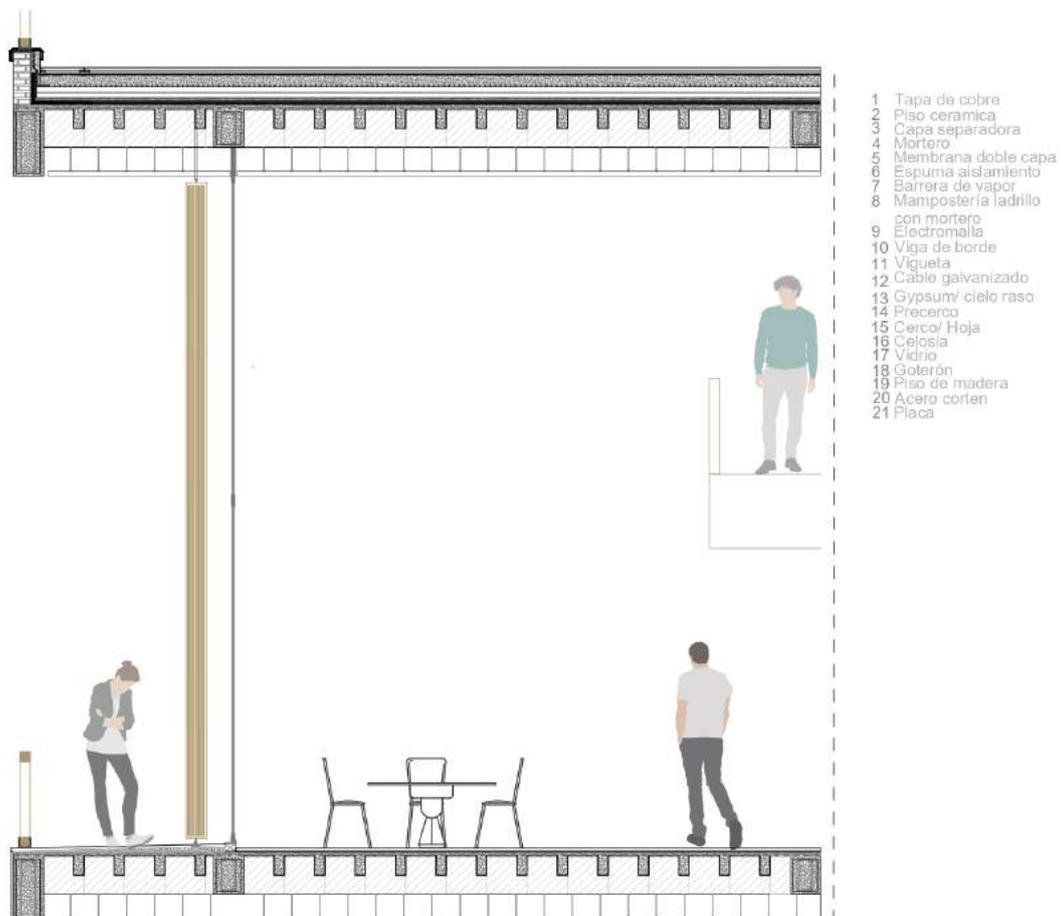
Corte arquitectónico constructivo de pizzería. Elaboración propia
